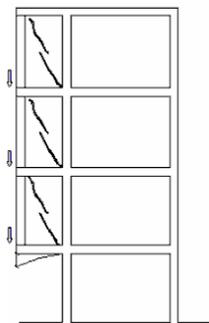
Fisuración por acumulación de cargas en voladizos
